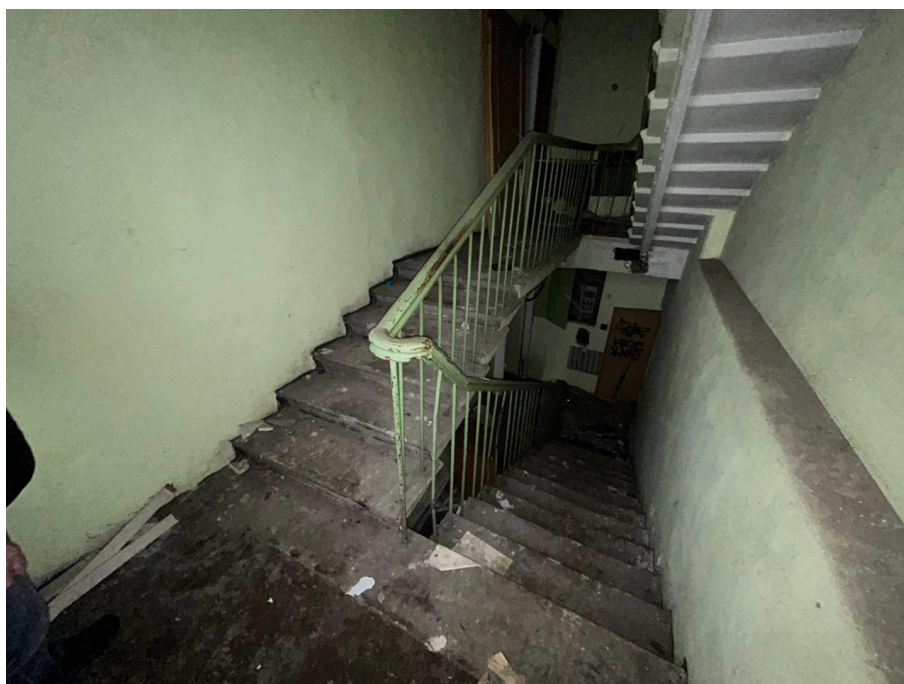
Междуэтажная площадка между 1-м и 2-м этажами.
